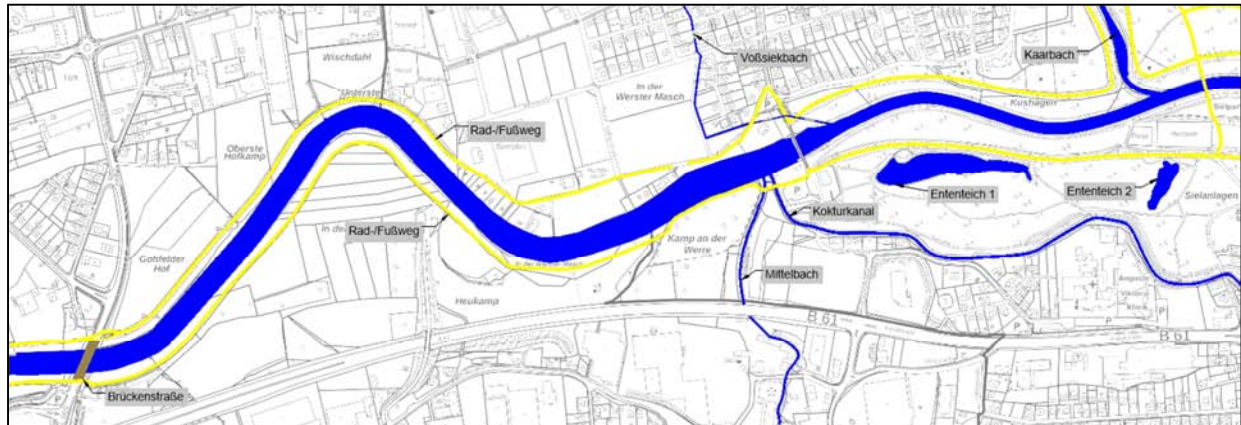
Lageplan Bestand mit Rad-/Fußwegeverlauf in Gelb, unterer Bereich
